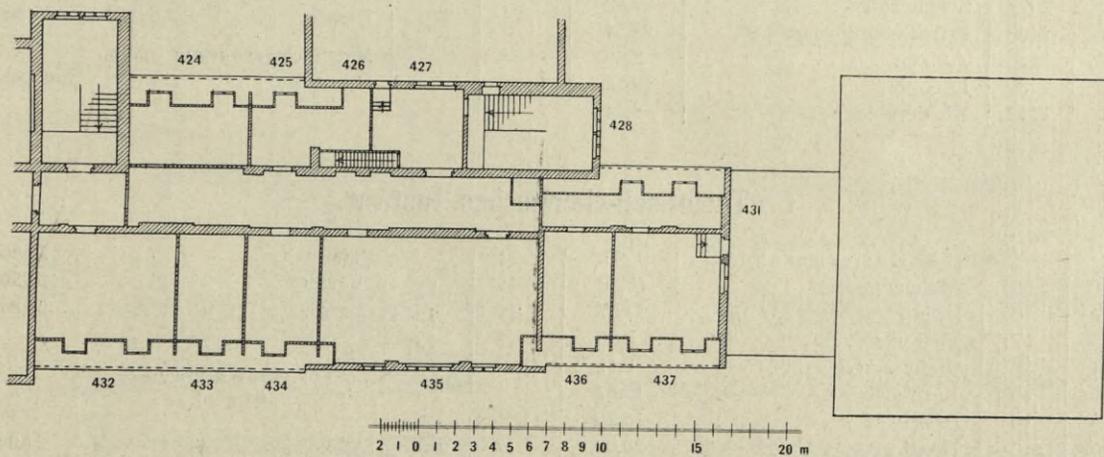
Anorgan.-chem. Institut. Dachgeschoß.
